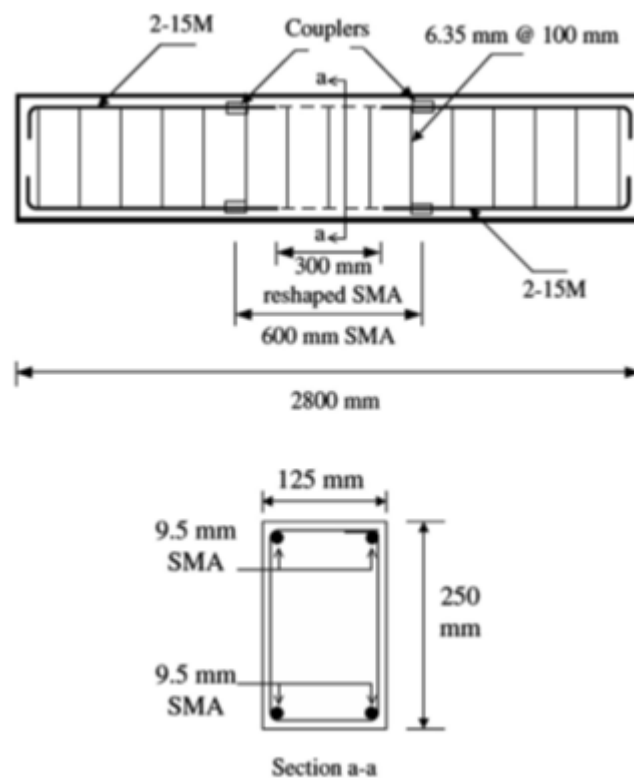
Détails de renforcement des poutres renforcées AMF (Abdulridha , Palermo et al,2013).
